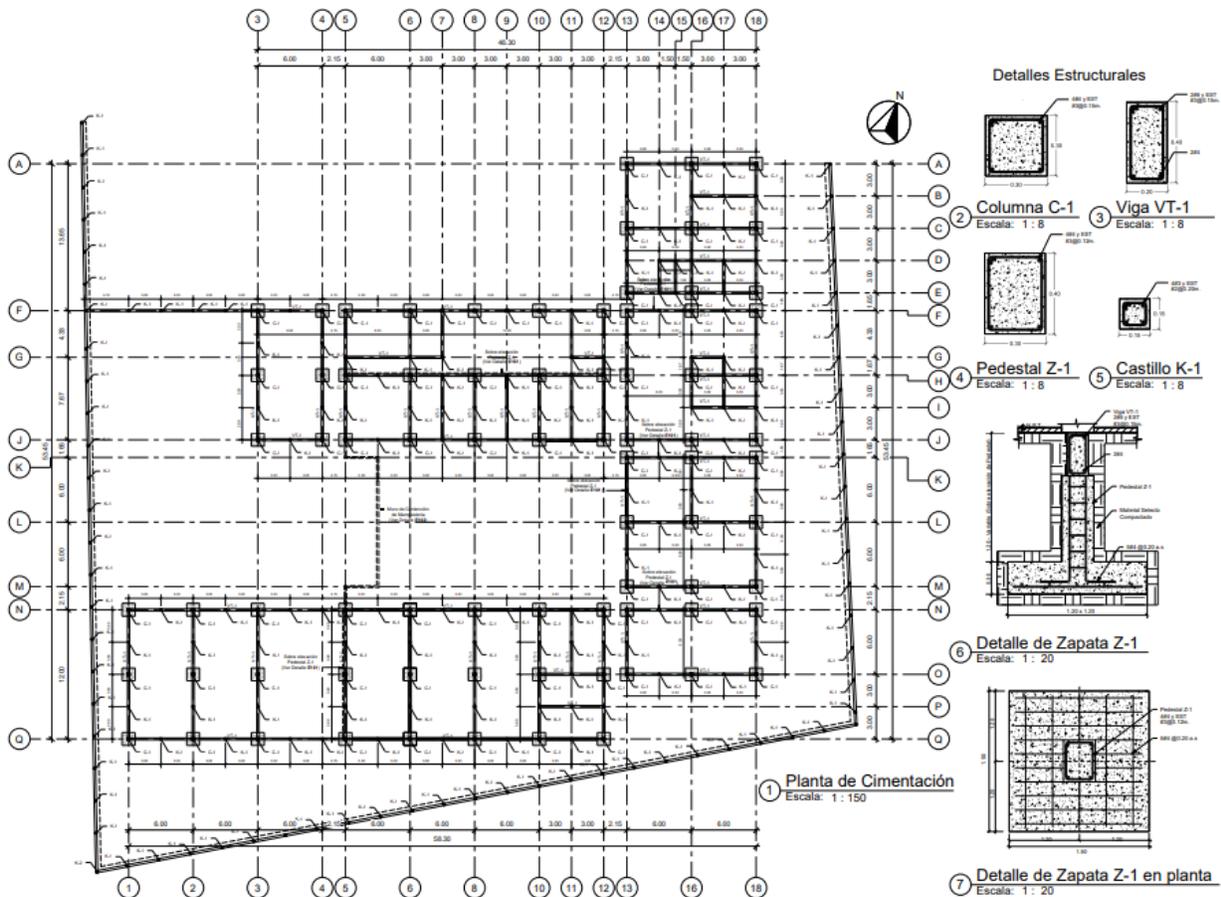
Planta de cimentación. Fuente: Elaboración propia
